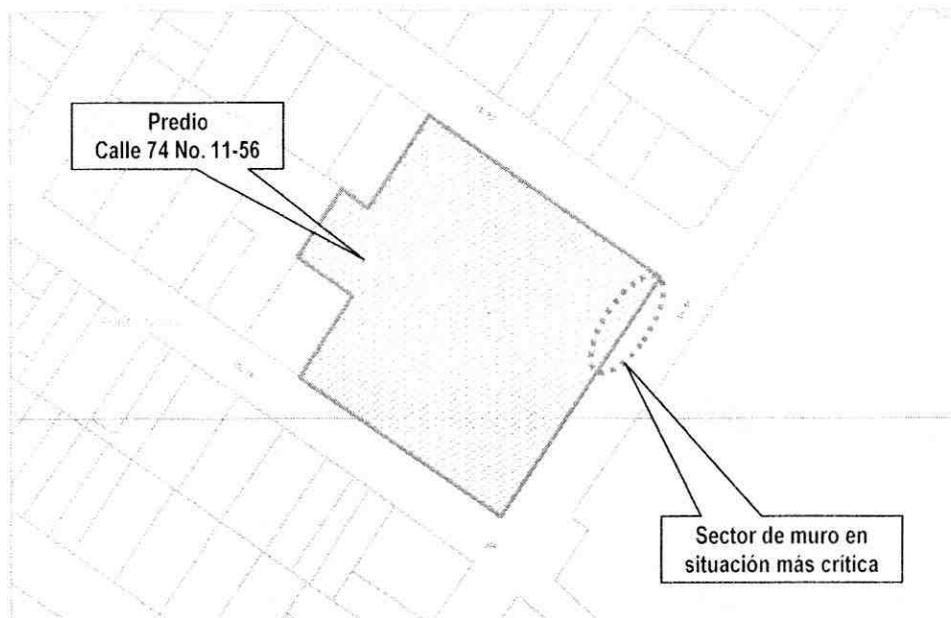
Localización del muro del costado oriental del predio de la Calle 74 No. 11-56, afectado por agrietamiento.
